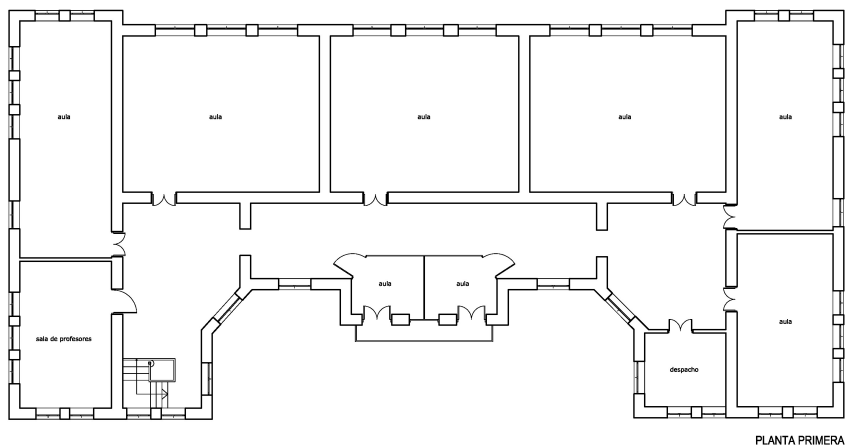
Plano de Planta Primera del C.E.I.P. Fabián y Fuero (Fuente: Elaboración propia).
